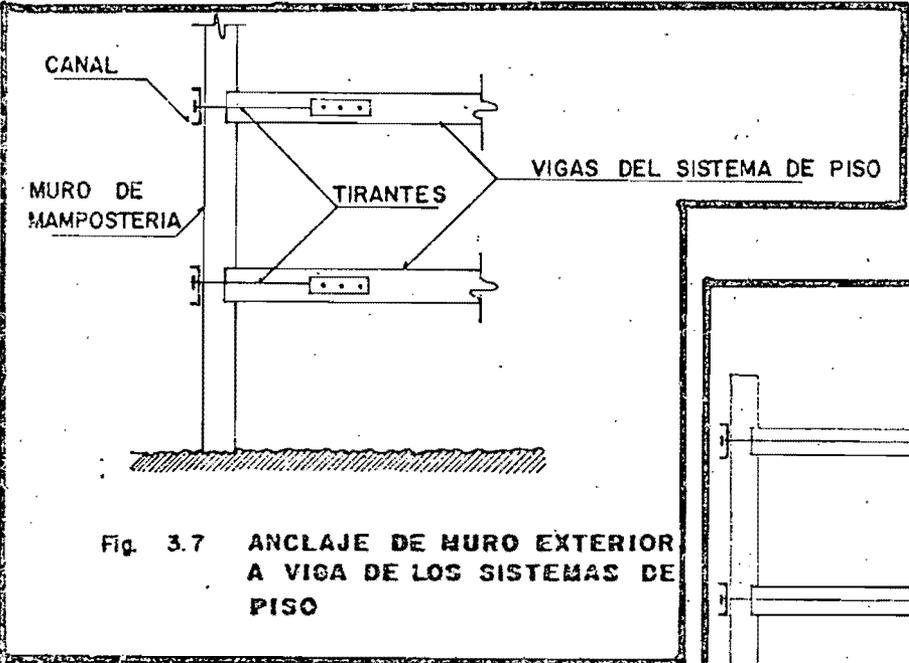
ANCLAJE DE MURO EXTERIOR A VIGA DE LOS SISTEMAS DE PISO
